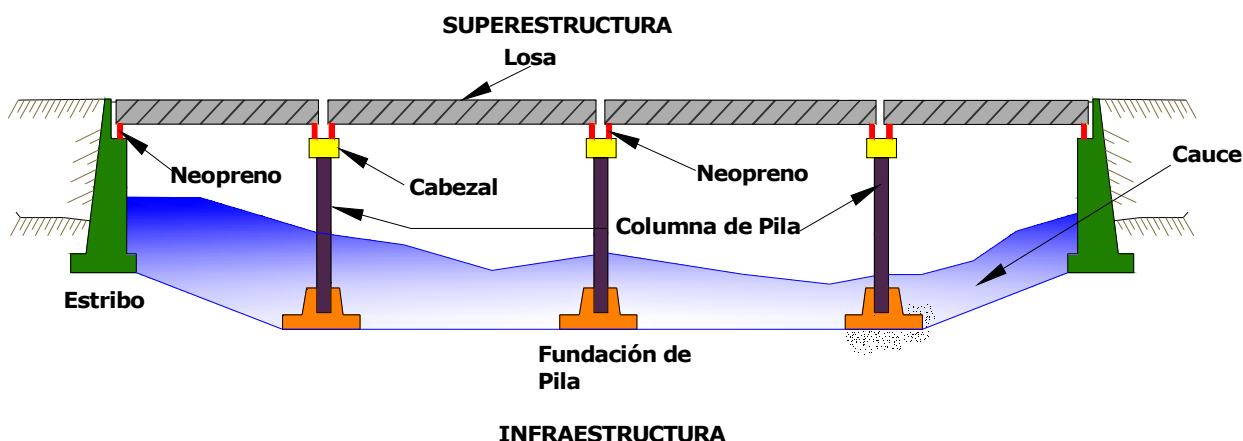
Puente Tipo de losa maciza de concreto armado
